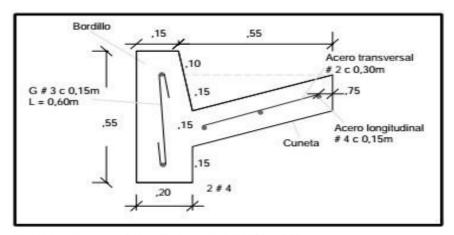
Corte Berma-cuneta Sección en la Cuneta
